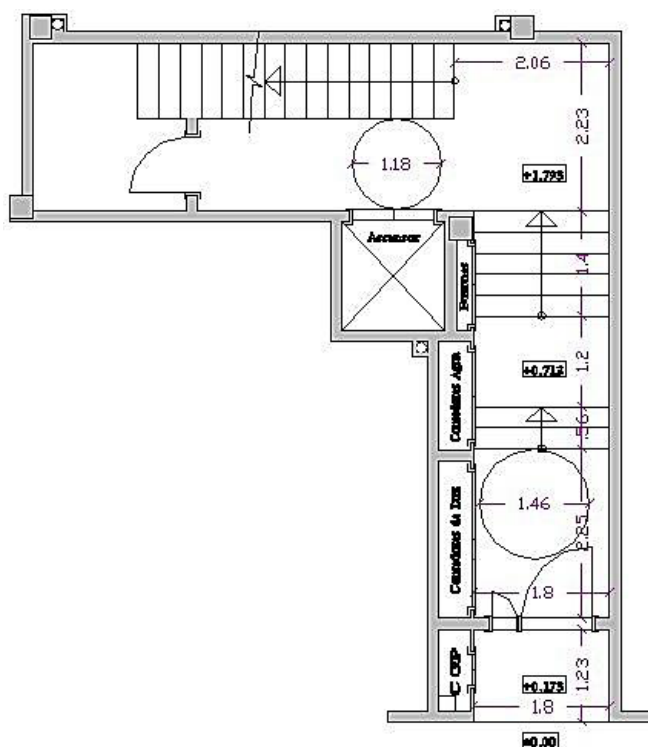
Accesibilidad planta baja [Anexo II. Planos]
